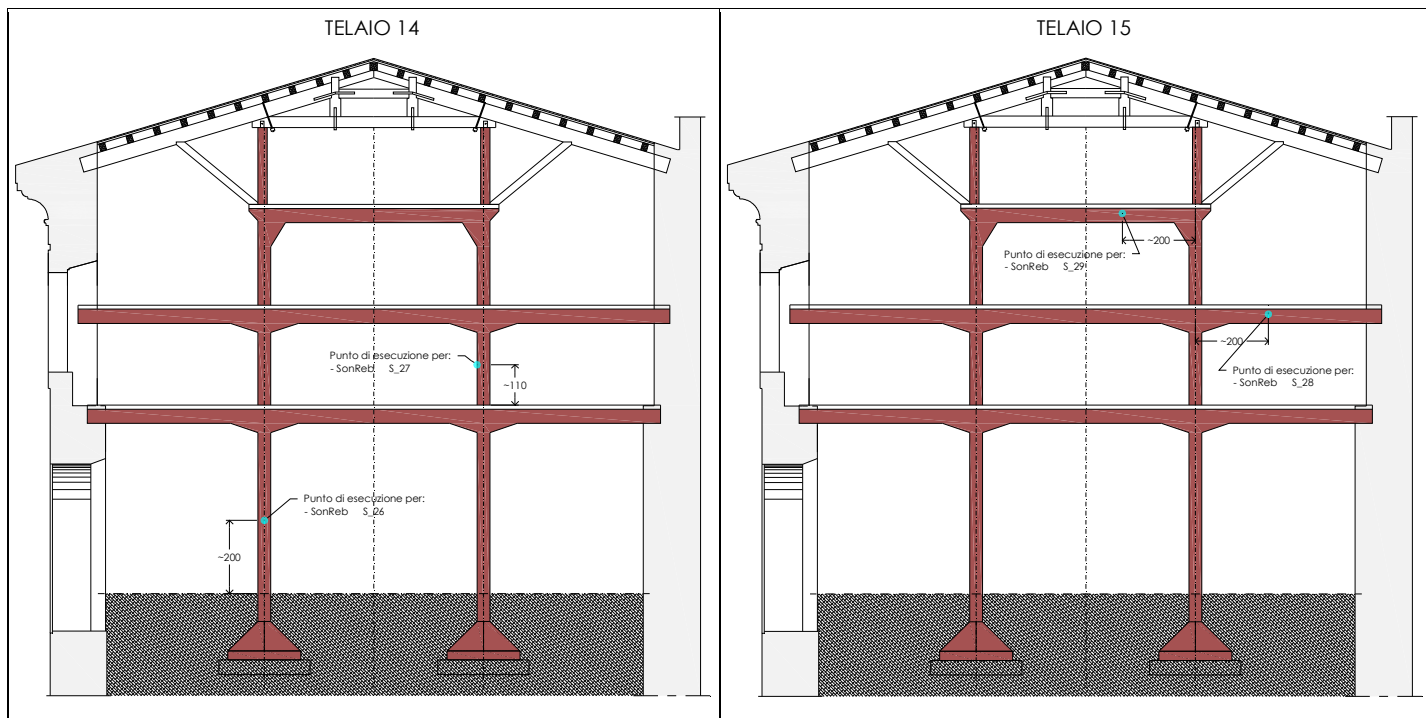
Posizione delle prove SonReb sui telai 14 e 15
